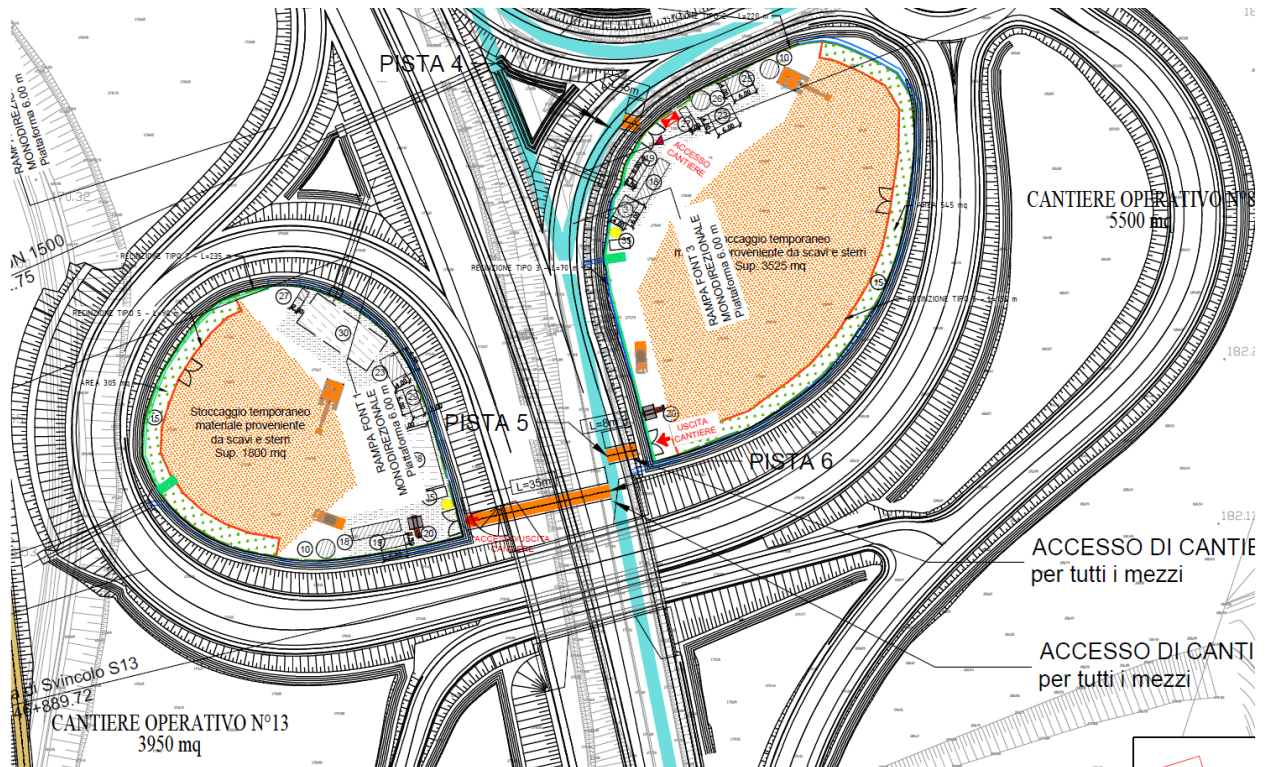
Planimetria cantiere operativo 8 e cantiere operativo 13.
